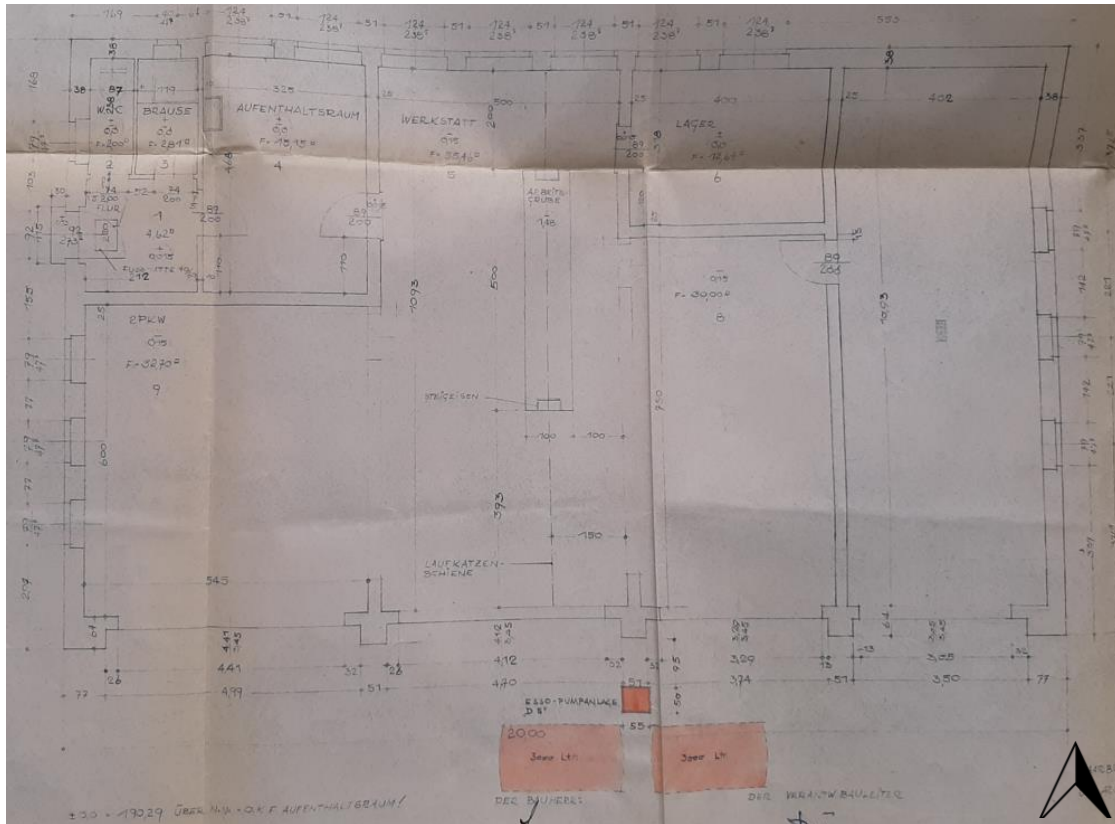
Planung eines Garagengebäudes mit Werkstatt (mit Benzinabscheider) und einer Tankanlage mit Zapfsäulen (rot markiert) um 1950/1951
